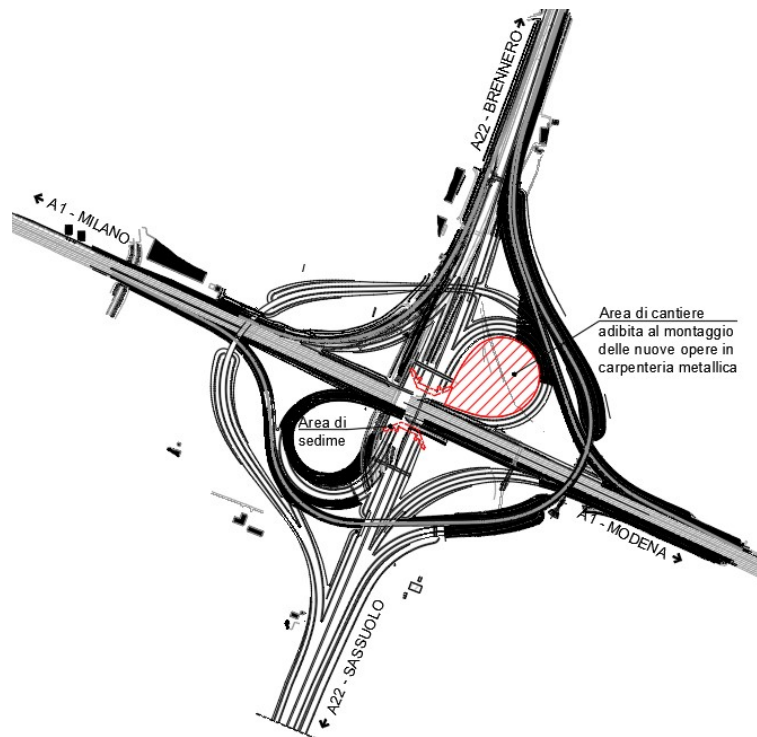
Planimetria di progetto del nuovo svincolo di interconnessione A22 - A1
